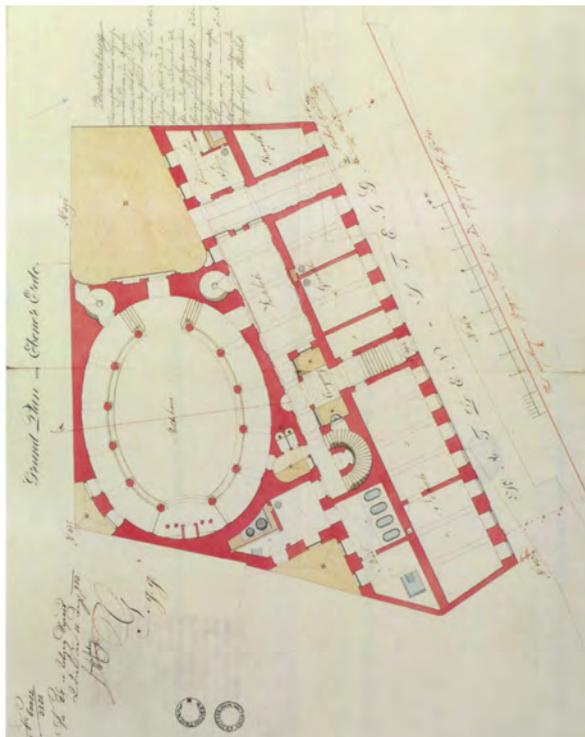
Wiener Stadttempel, Ausführungsprojekt, Grundriss, Joseph Kornhäusel, 1823
